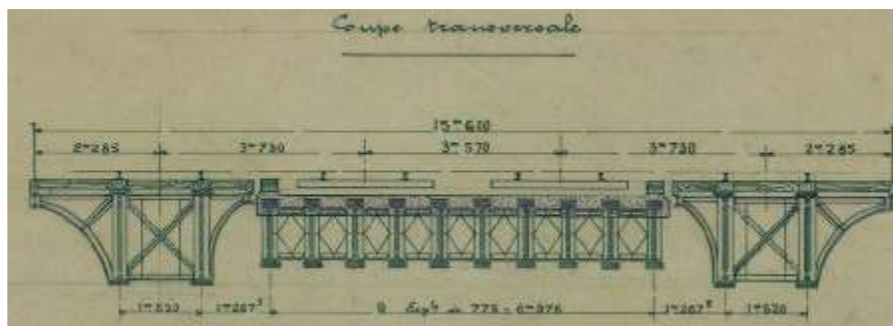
Coupe transversale actuelle du PRA Le Chatelier
